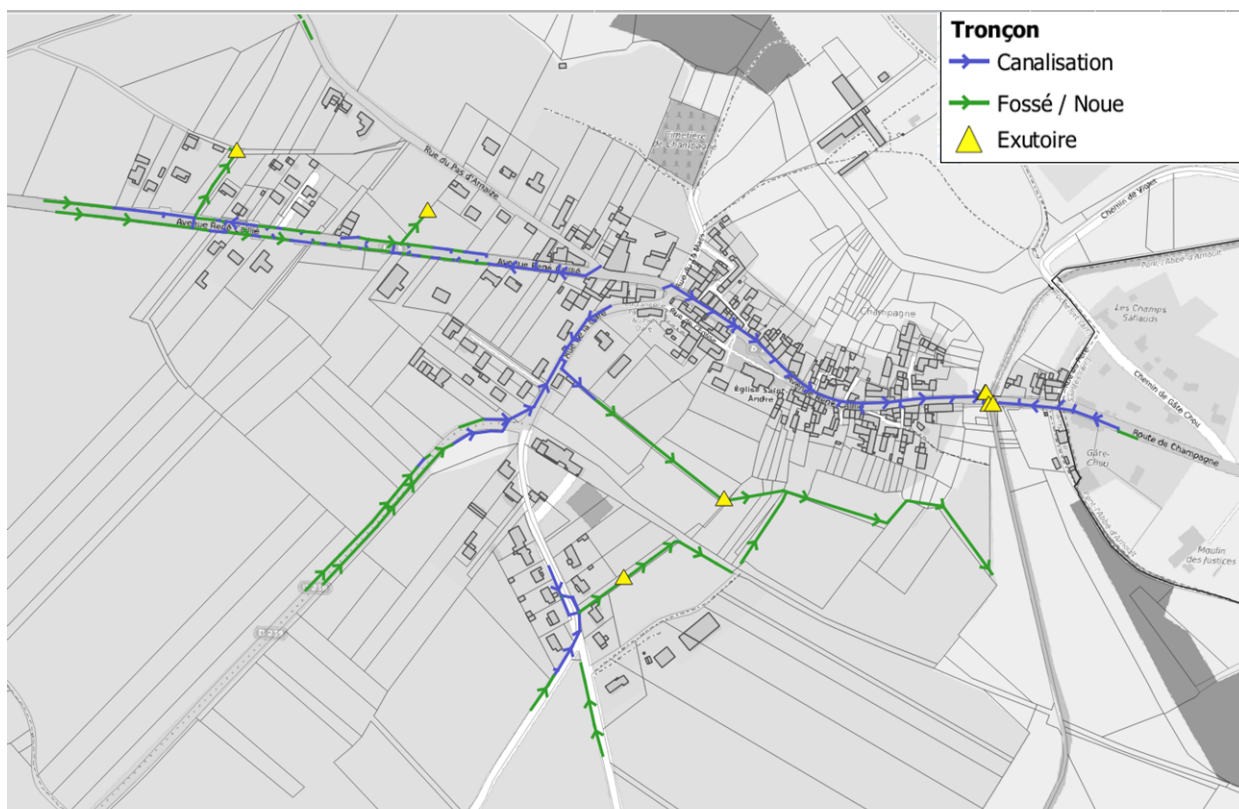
Extrait du plan des réseaux d'eaux pluviales
